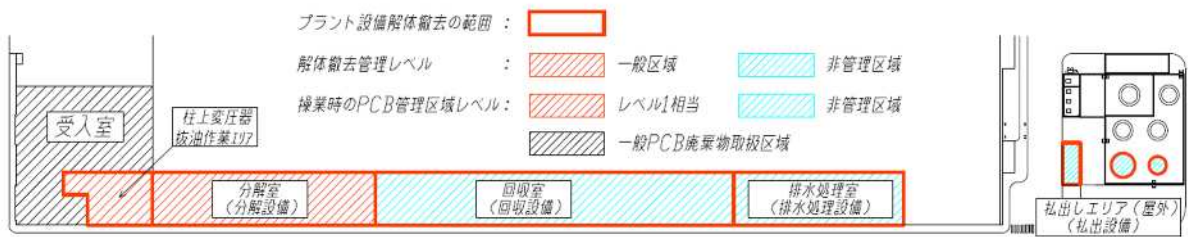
低濃度 PCB 処理施設 プラント設備の撤去範囲
